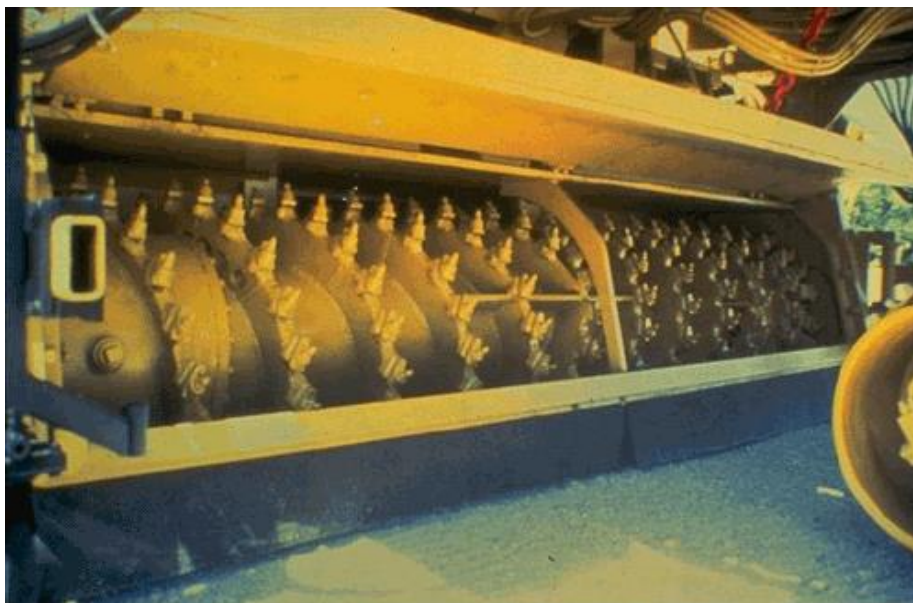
Vista do cilindro fresador de uma máquina fresadora
